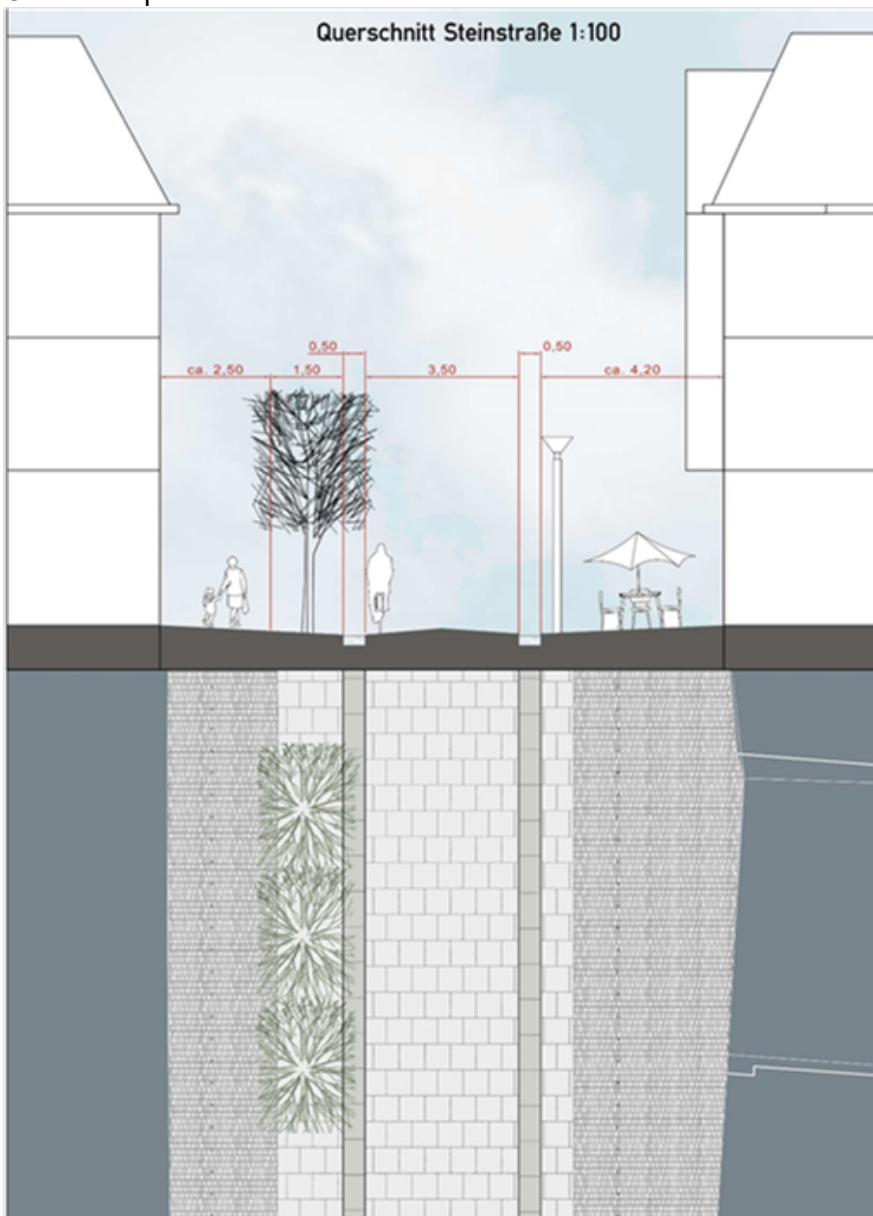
Testentwurf Querschnitt Steinstraße, Quelle plan b
